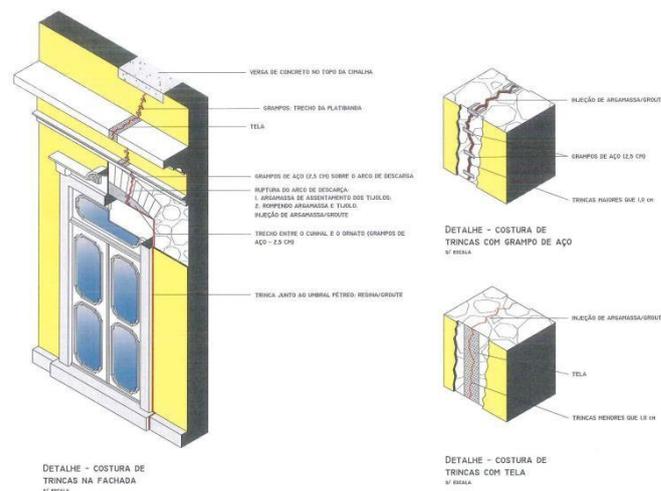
Detalhamento do INEPAC para recuperar as trincas e fissuras na fachada do Museu Naval
